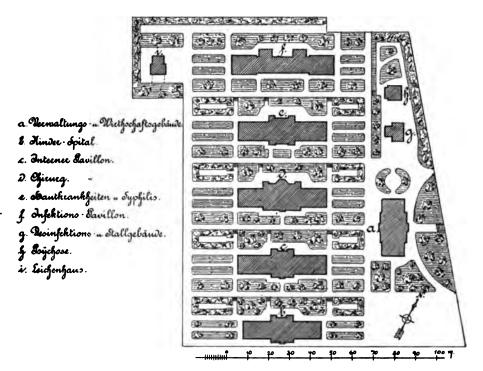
Neues Krankenhaus in Aussig. Lageplan.
